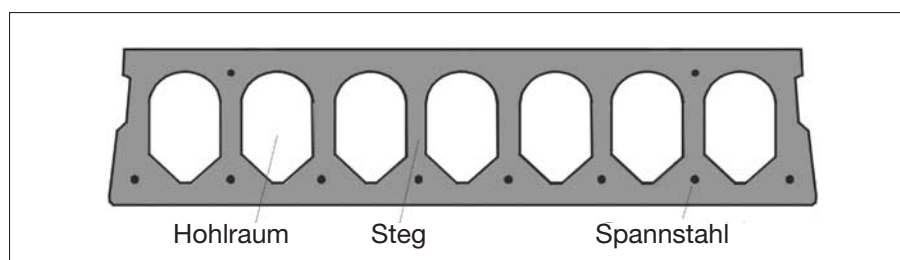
Querschnitt einer Spannbeton-Fertigdecke
